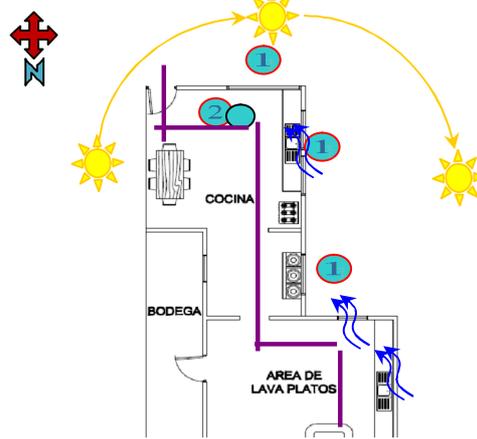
Planta Arquitectónica de la cocina. Fuente: Propia
